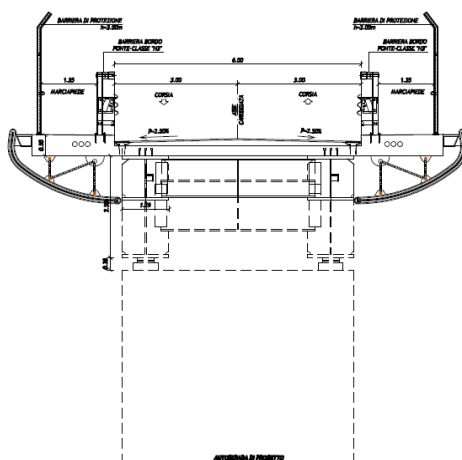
SEZIONE TIPO IMPALCATO CAVALCAVIA DI STRADA COMUNALE
